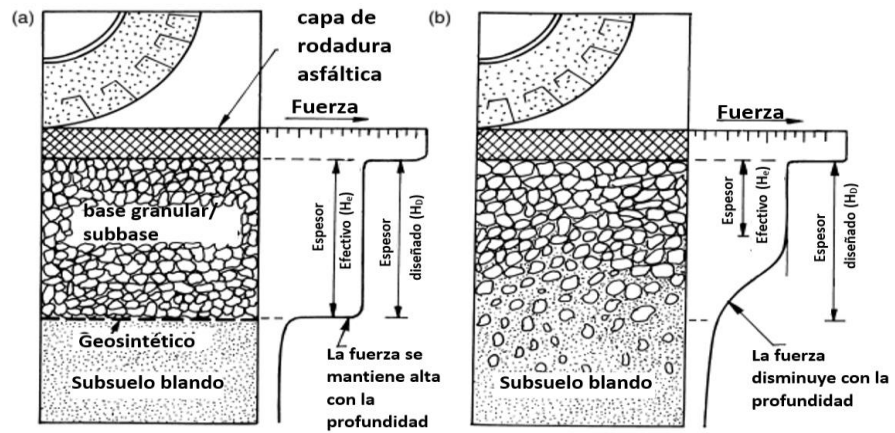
Concepto de separación geosintética en calzadas pavimentadas (modificado de Rankilor, 1981)
